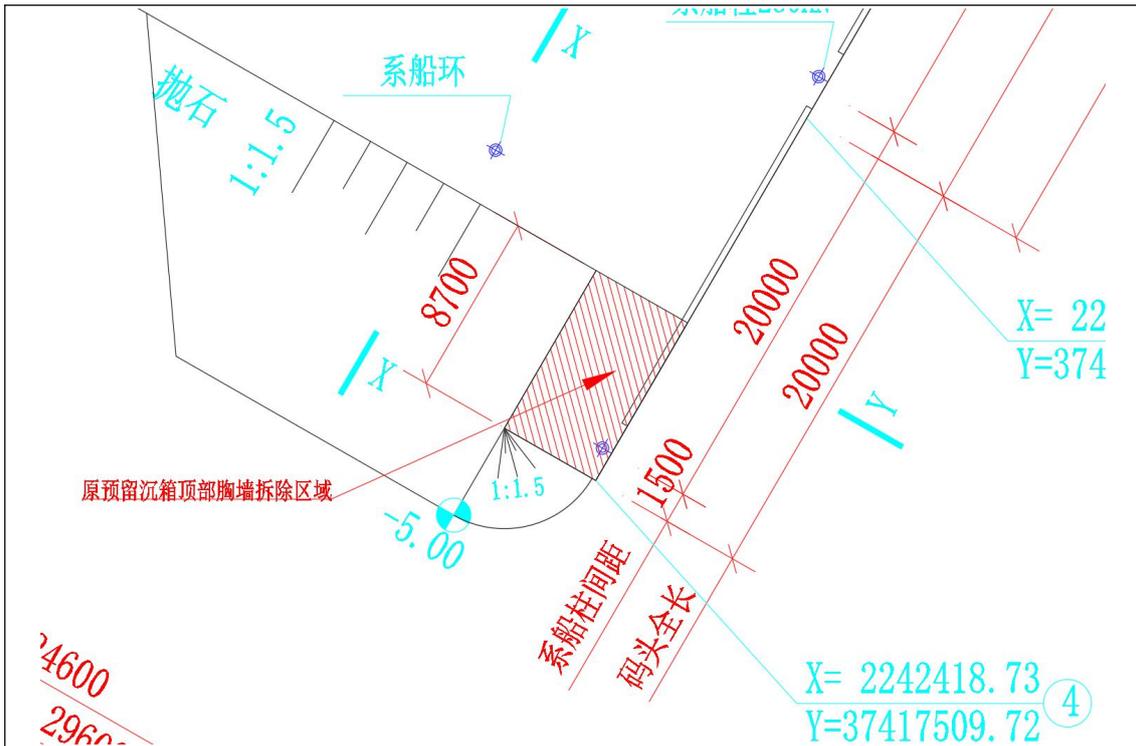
原预留沉箱顶部胸墙平面图
